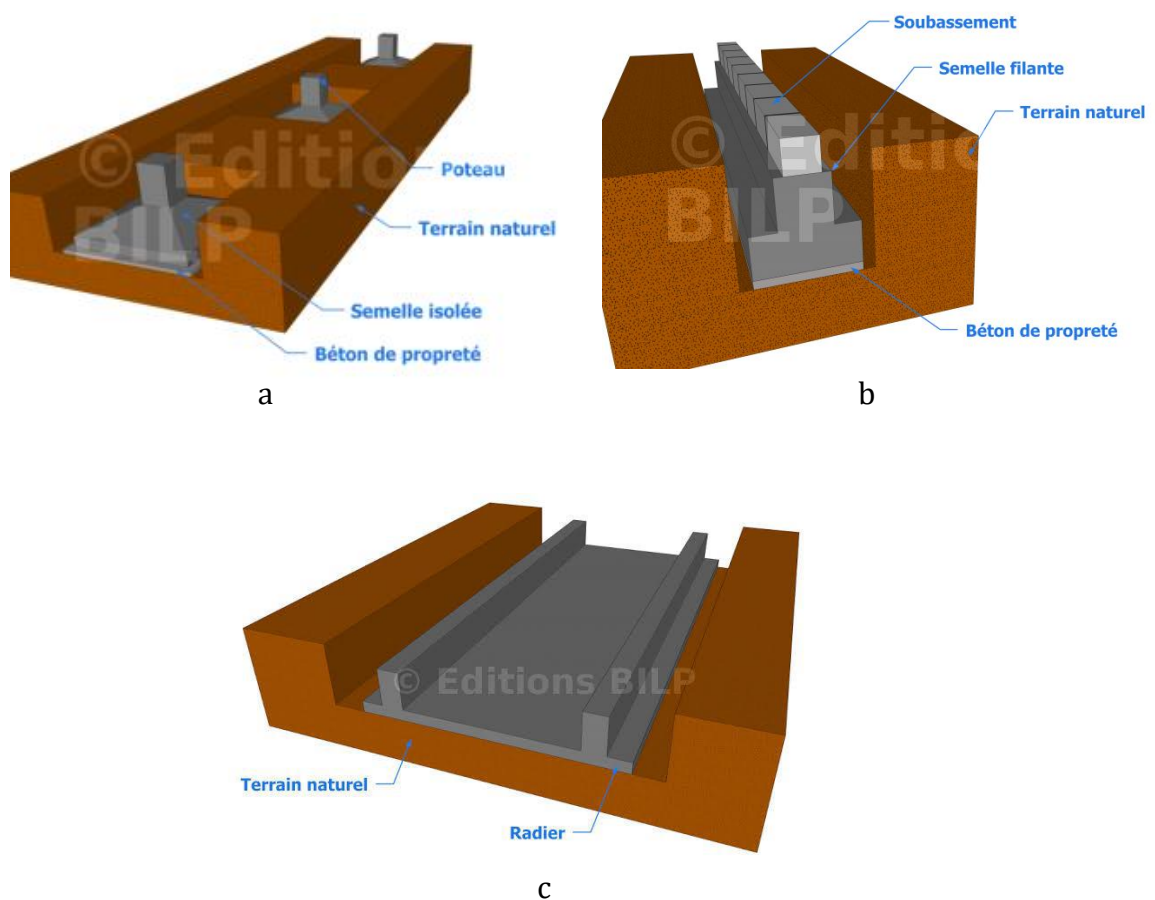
Fondations superficielles (a : isolée, b : filante et c : radier)
